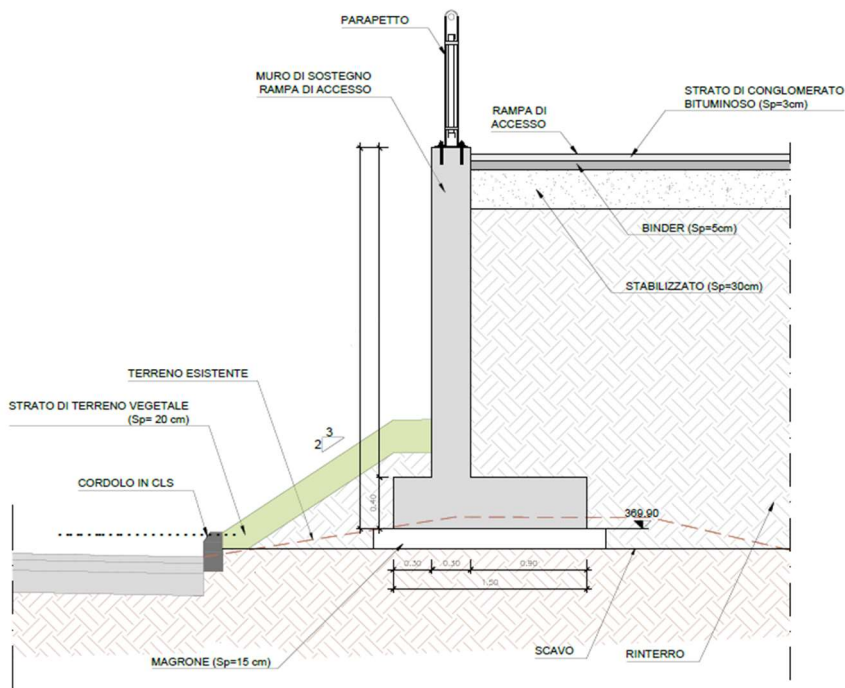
Dimensioni geometriche del muro tipico tratto B-B Est
